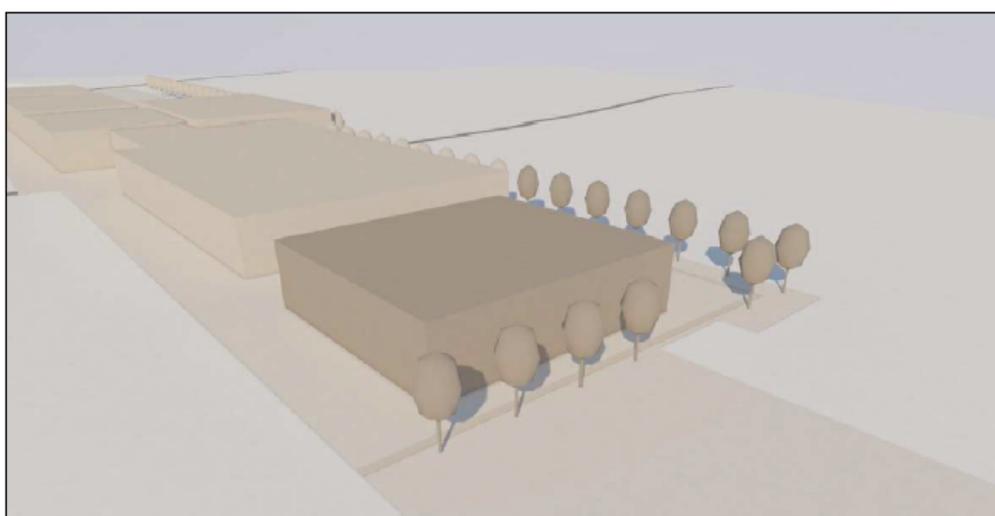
Render volumetrico – Vista dell'intervento con ripresa dal lato Sud-Ovest
